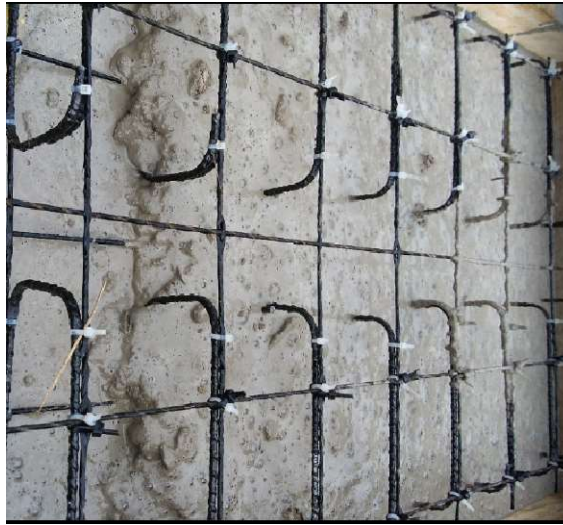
Laje maciça de concreto armado com GFRP, Curitiba/PR
